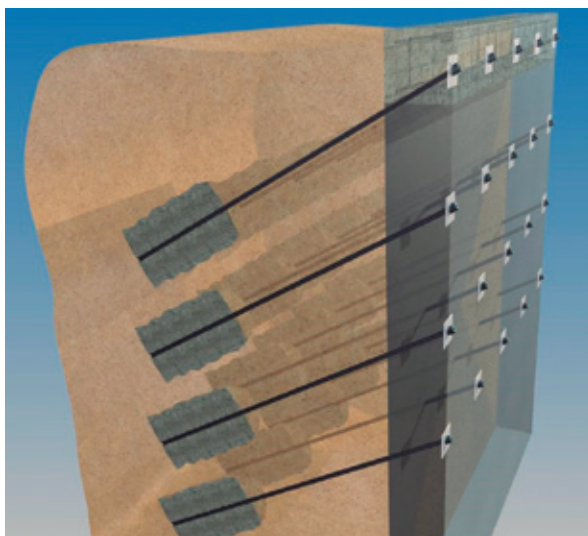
Tirantes Pretensado sub-horizontales para muros de contención.
